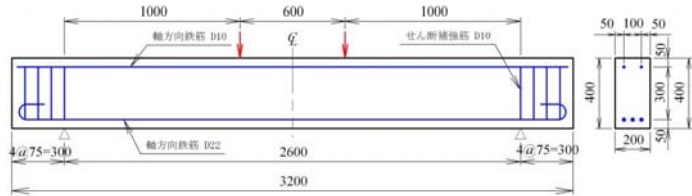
せん断補強鉄筋の無いせん断破壊型供試体の形状寸法および配筋状況
